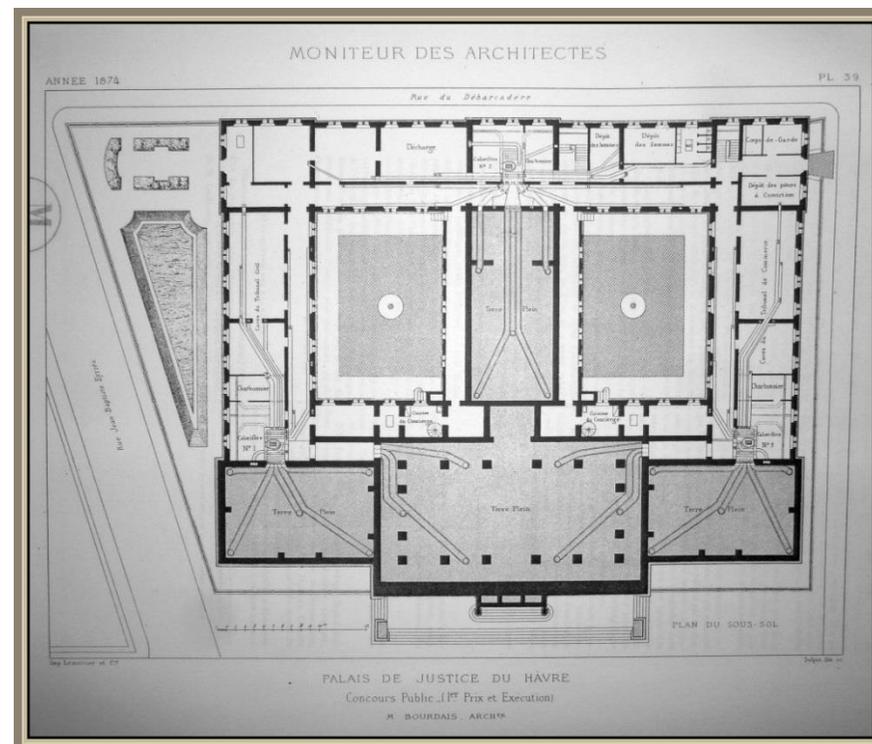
Plan du sous-sol, projet du 7 mai 1874
